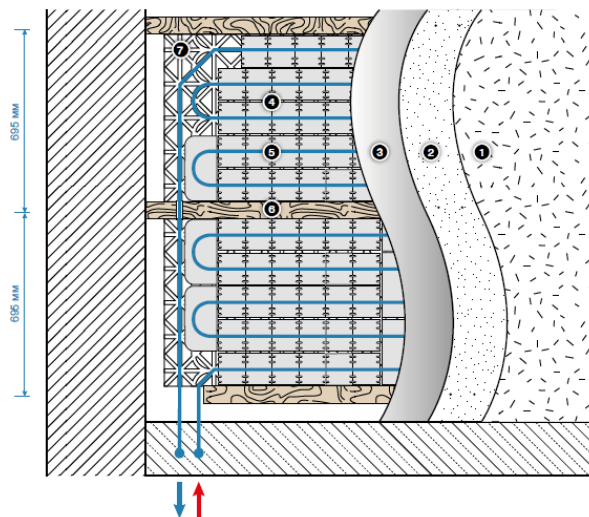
Конструкция стенового отопления Kan-therm TBS Wall (поперечный разрез):
